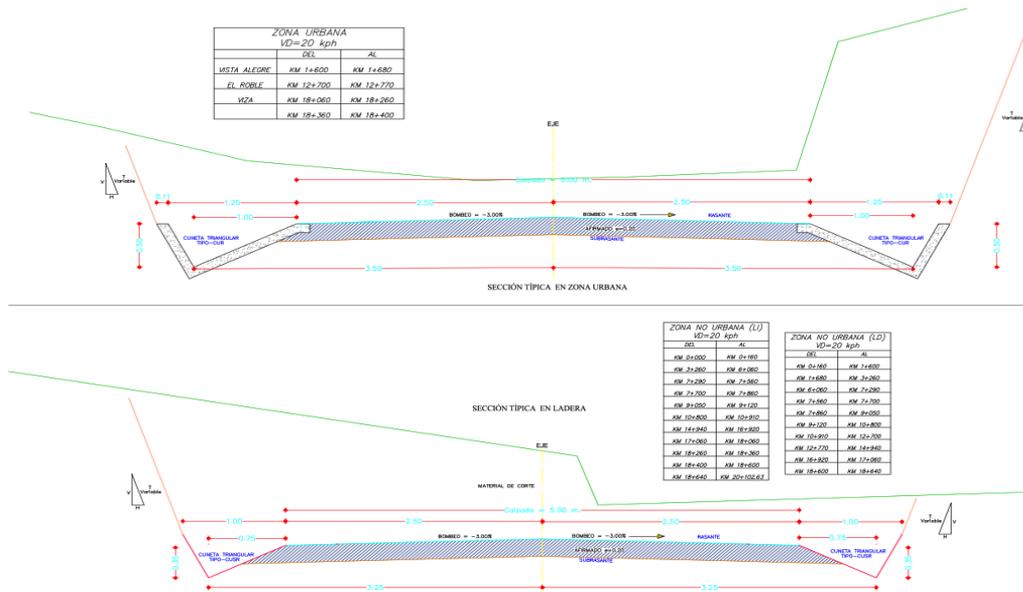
Ancho de calzada (Fuente: Expediente técnico)
